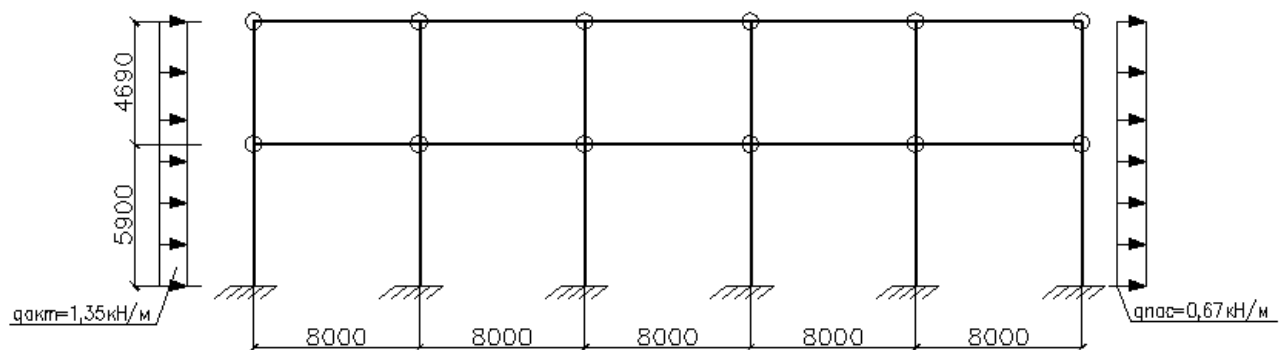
Розрахункова схема рами щодо вітрового навантаження
